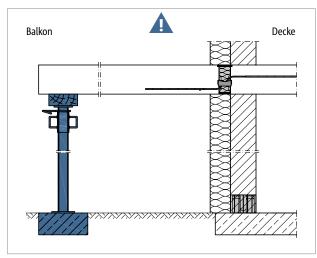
Schöck Isokorb® T Typ QL-VV: Stützung durchgängig erforderlich
